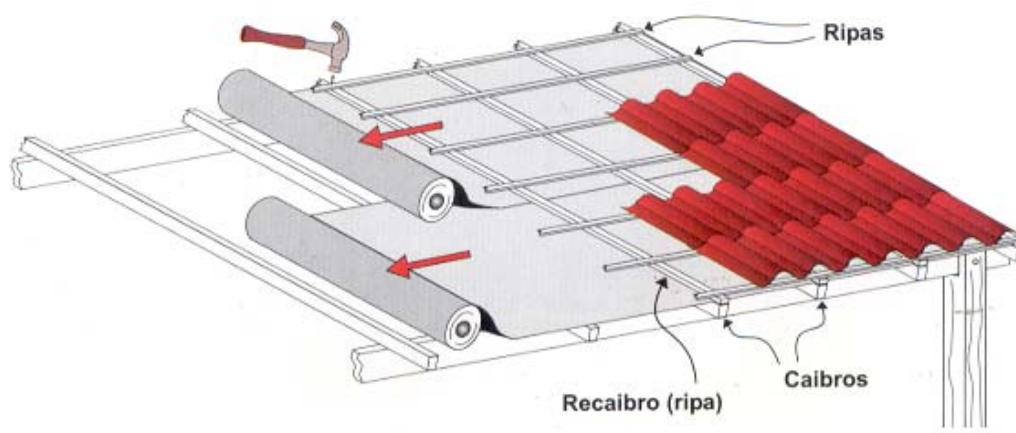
Esquema de montagem da subcobertura em telhado cerâmico.
